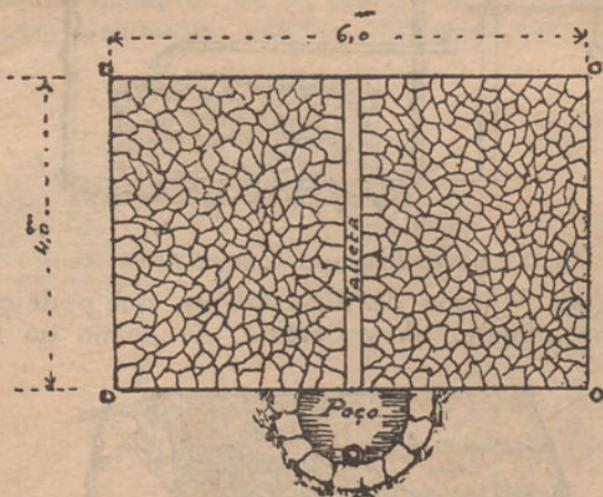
Estrumeira convexa e de cisterna lateral — Planta
